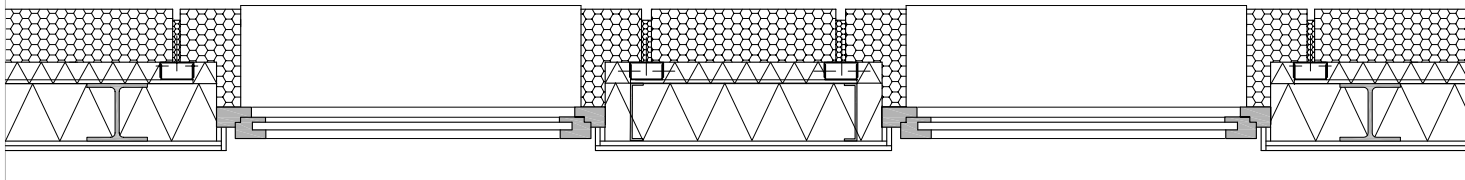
Schnitt Steildach, Aufbau 6a, M. 1:20
